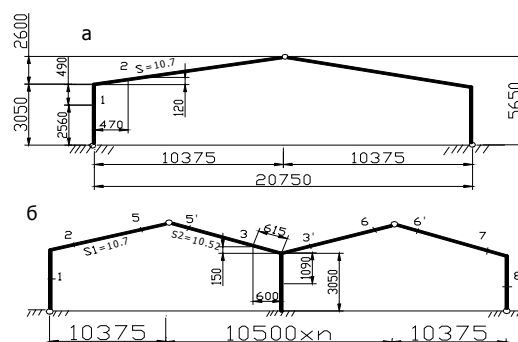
Расчетная схема рамного каркаса: а – однопролетного; б – многопролетного; 1–8 – расчетные сечения
